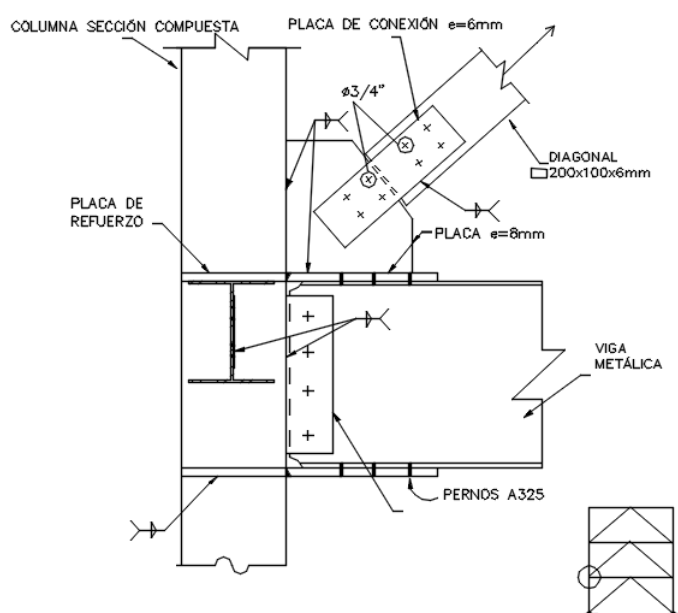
Detalle de elementos empleados para conexión tipo 1
